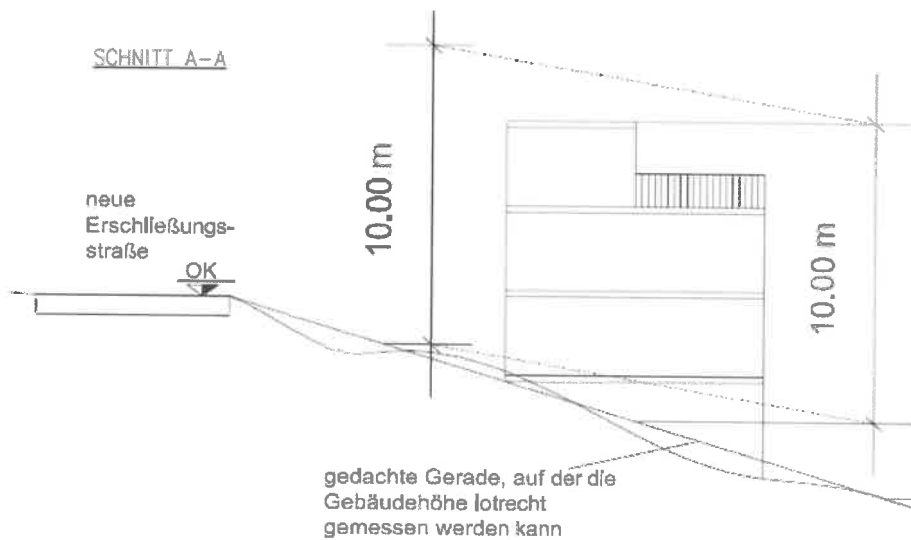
Schnitt zur Ermittlung des Bezugshorizontes
